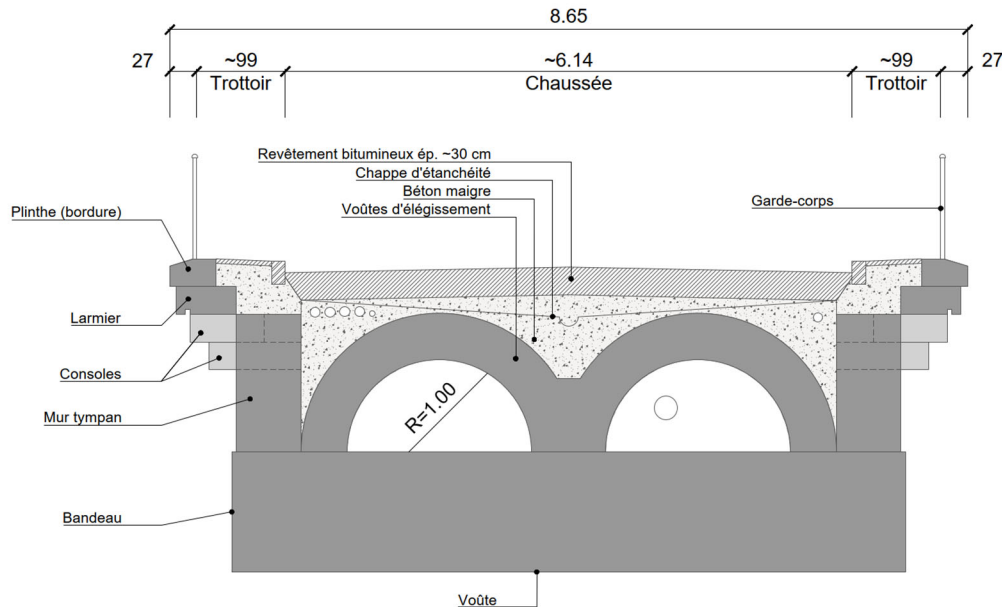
Coupe transversale à la clé de voûte du pont de Brent
